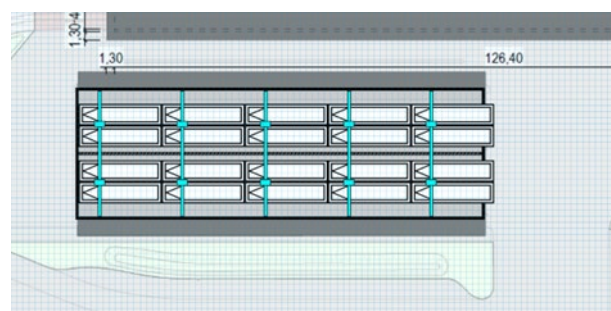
Planausschnitt Abstellhalle für BEV mit vier Spuren und Brandschutzwand
